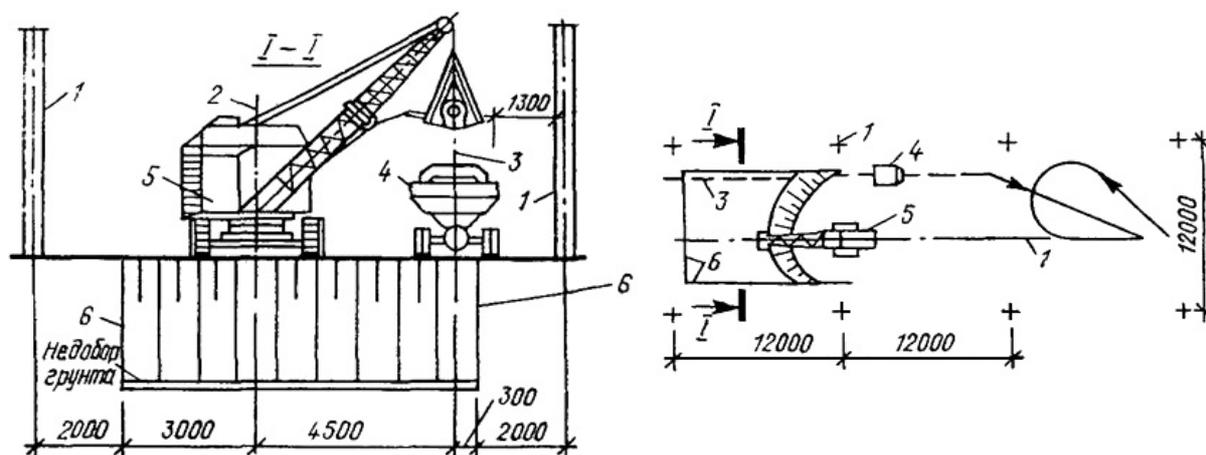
Схема разработки грунта в котловане экскаватором с грейфером:
